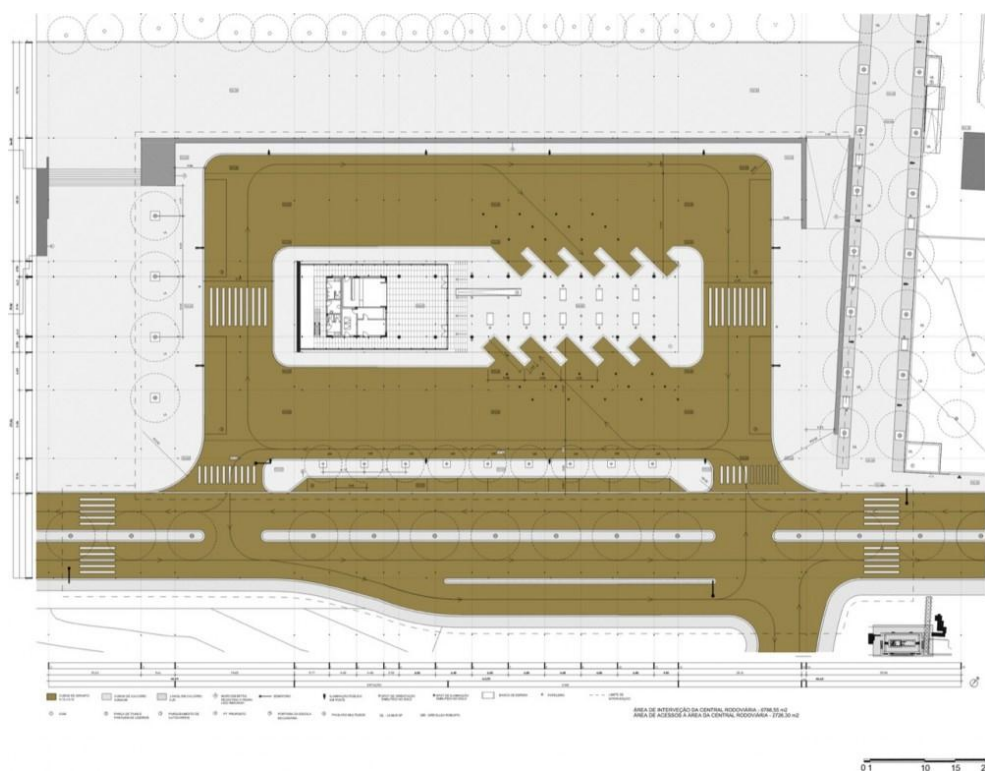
Planta baixa do Terminal Rodoviário de Rio Maior
